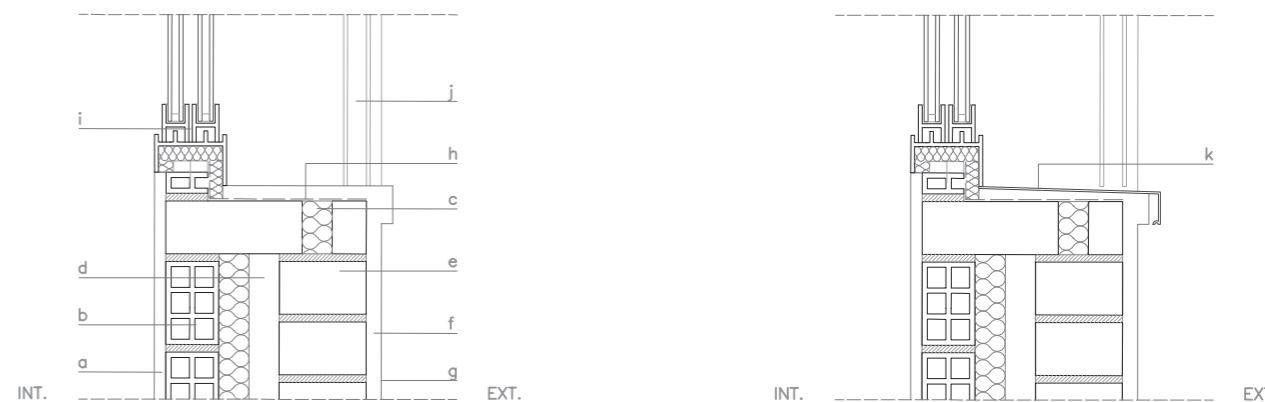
Detalle constructivo. Ventana tipo 2. Fachada principal. [Tabla 1]
